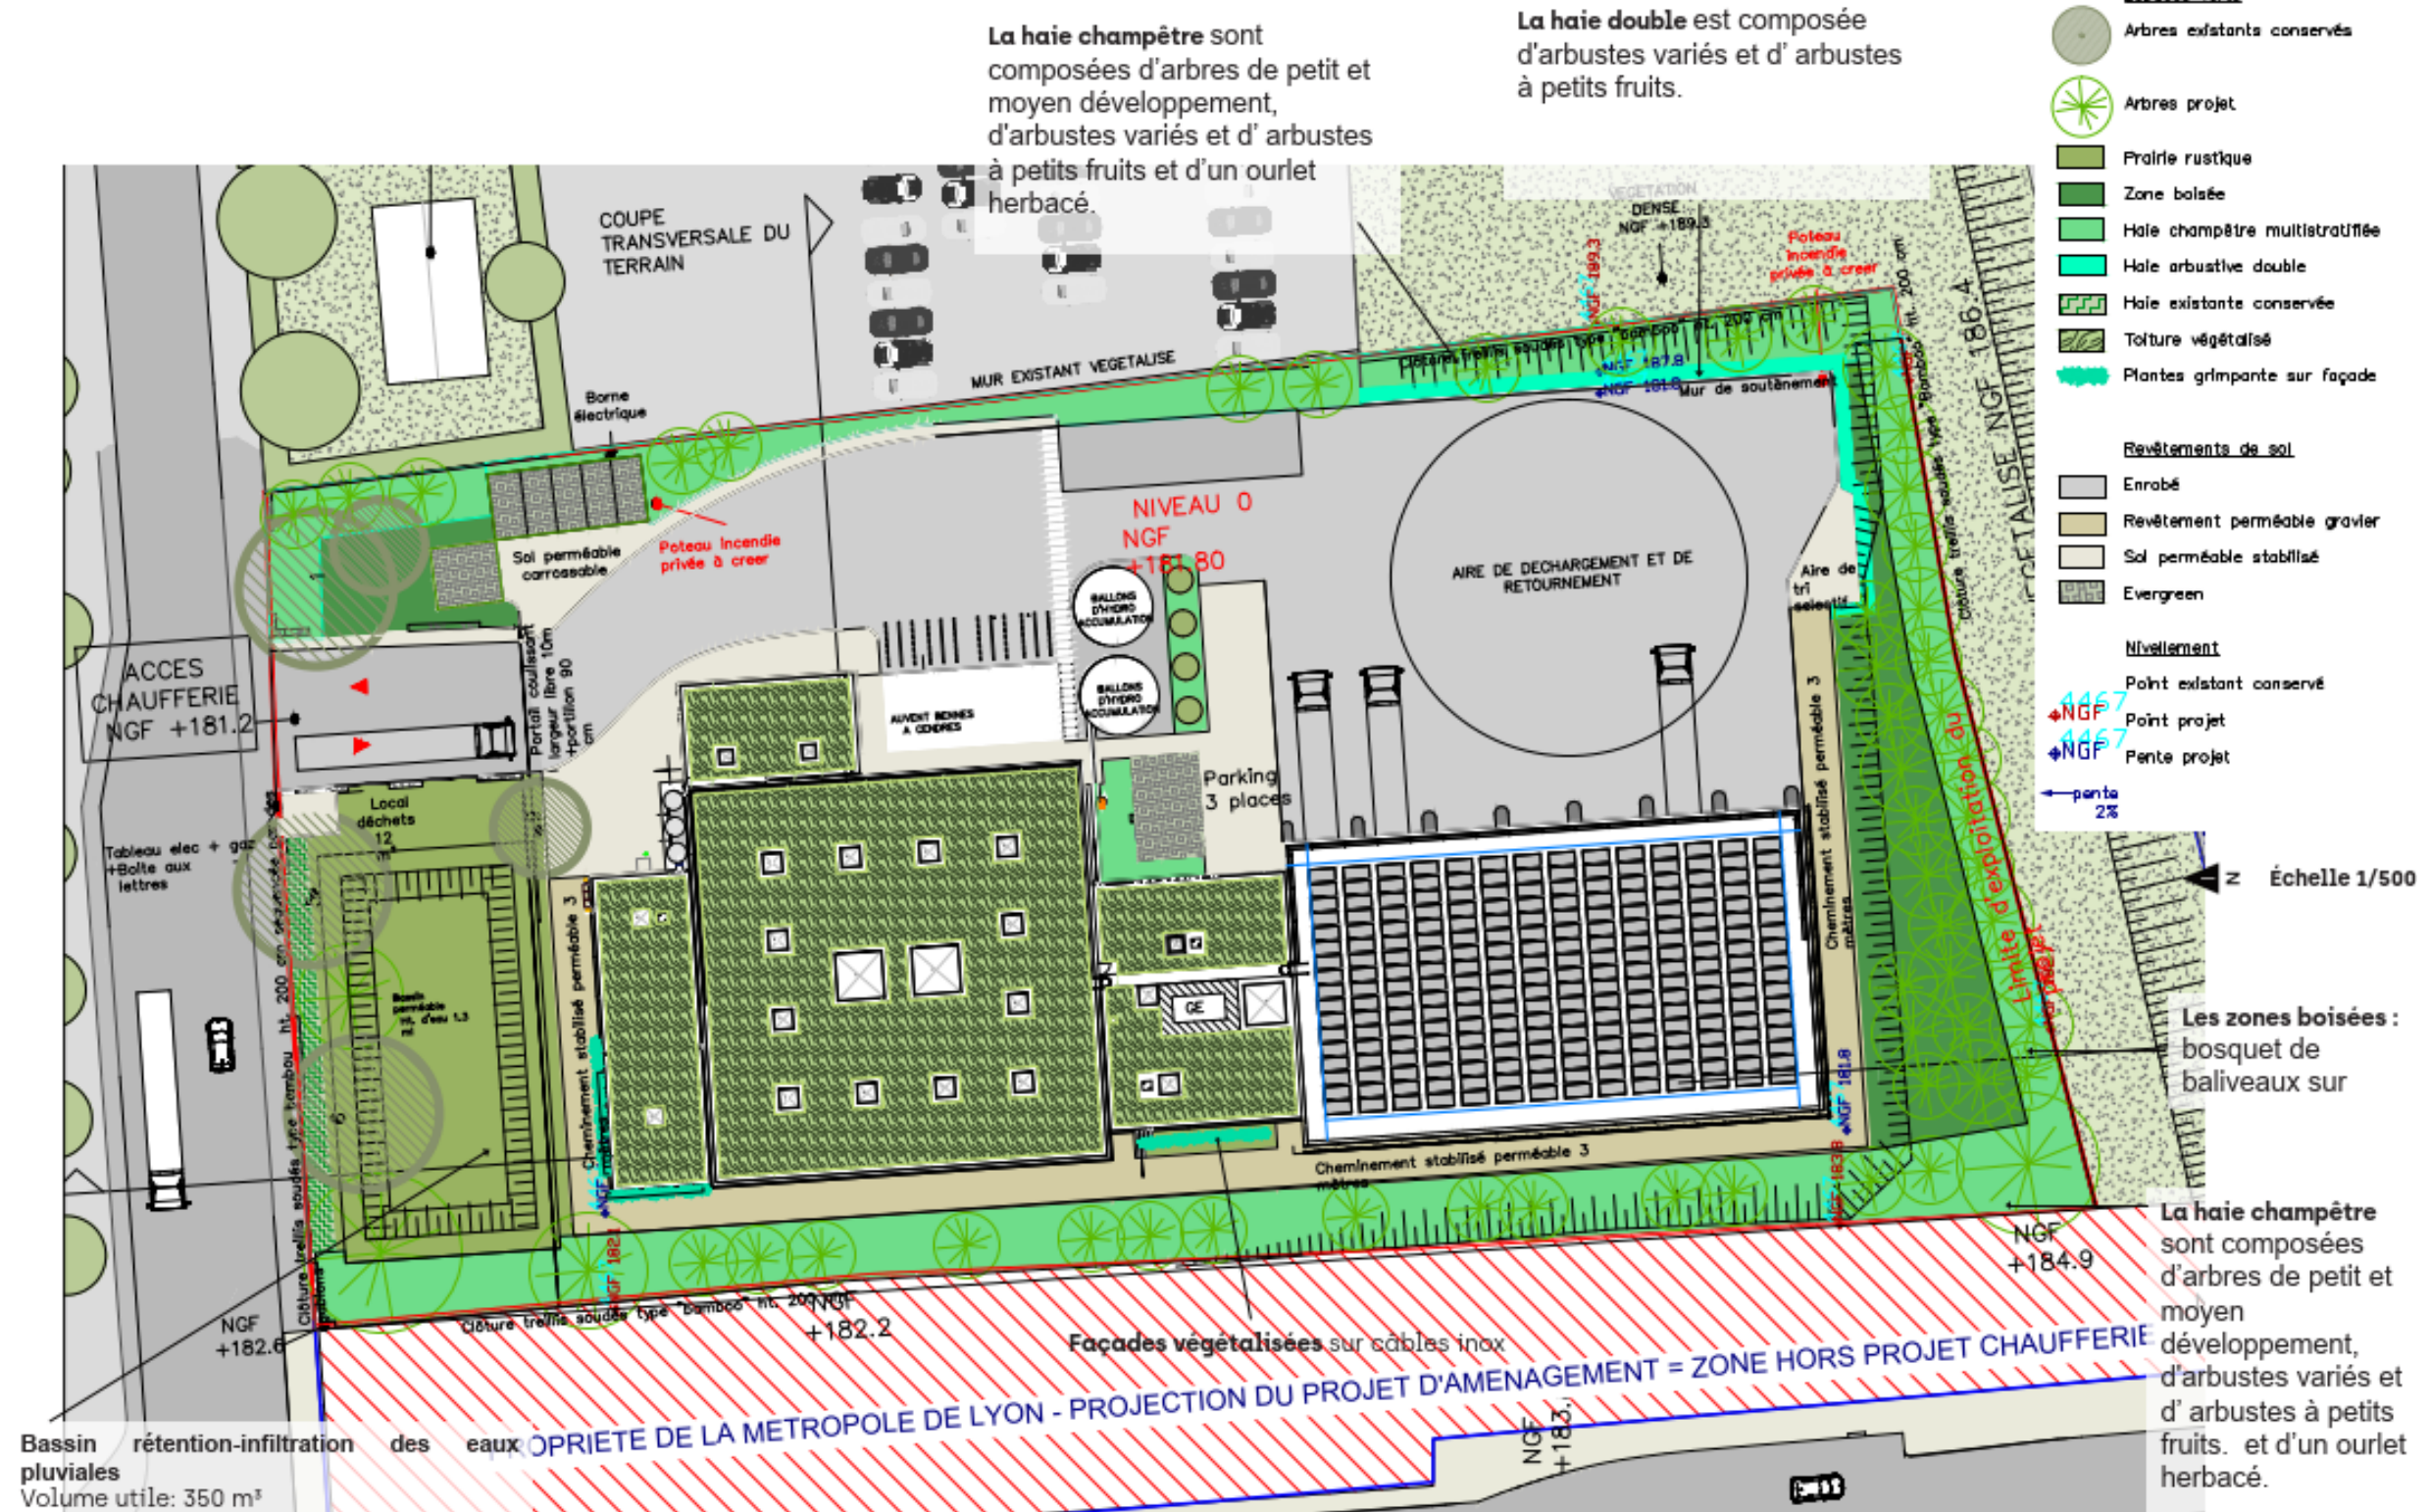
Plan masse paysager © Le Perchoir Paysage
